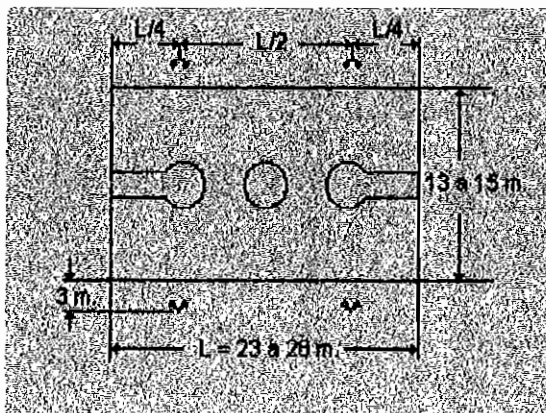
Disposición normal de luminarias en pistas descubiertas de baloncesto para entrenamiento.
